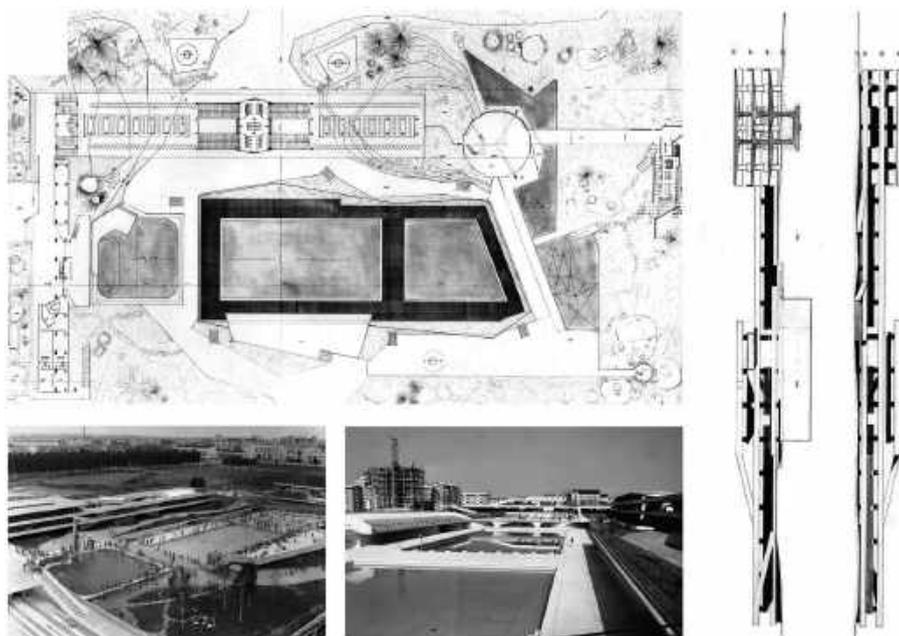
Sezione est, prospetto est verso l'ingresso su via Valfurva e pianta piano primo, disegni di progetto, vista fronte est-vista generale fronte nord e spalti
